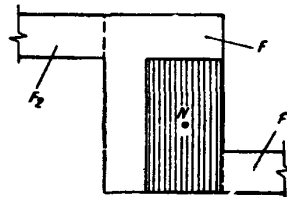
Расчетная схема сложного сечения при косом внецентренном сжатии; площади F_1 и F_2 в расчете не учитываются
